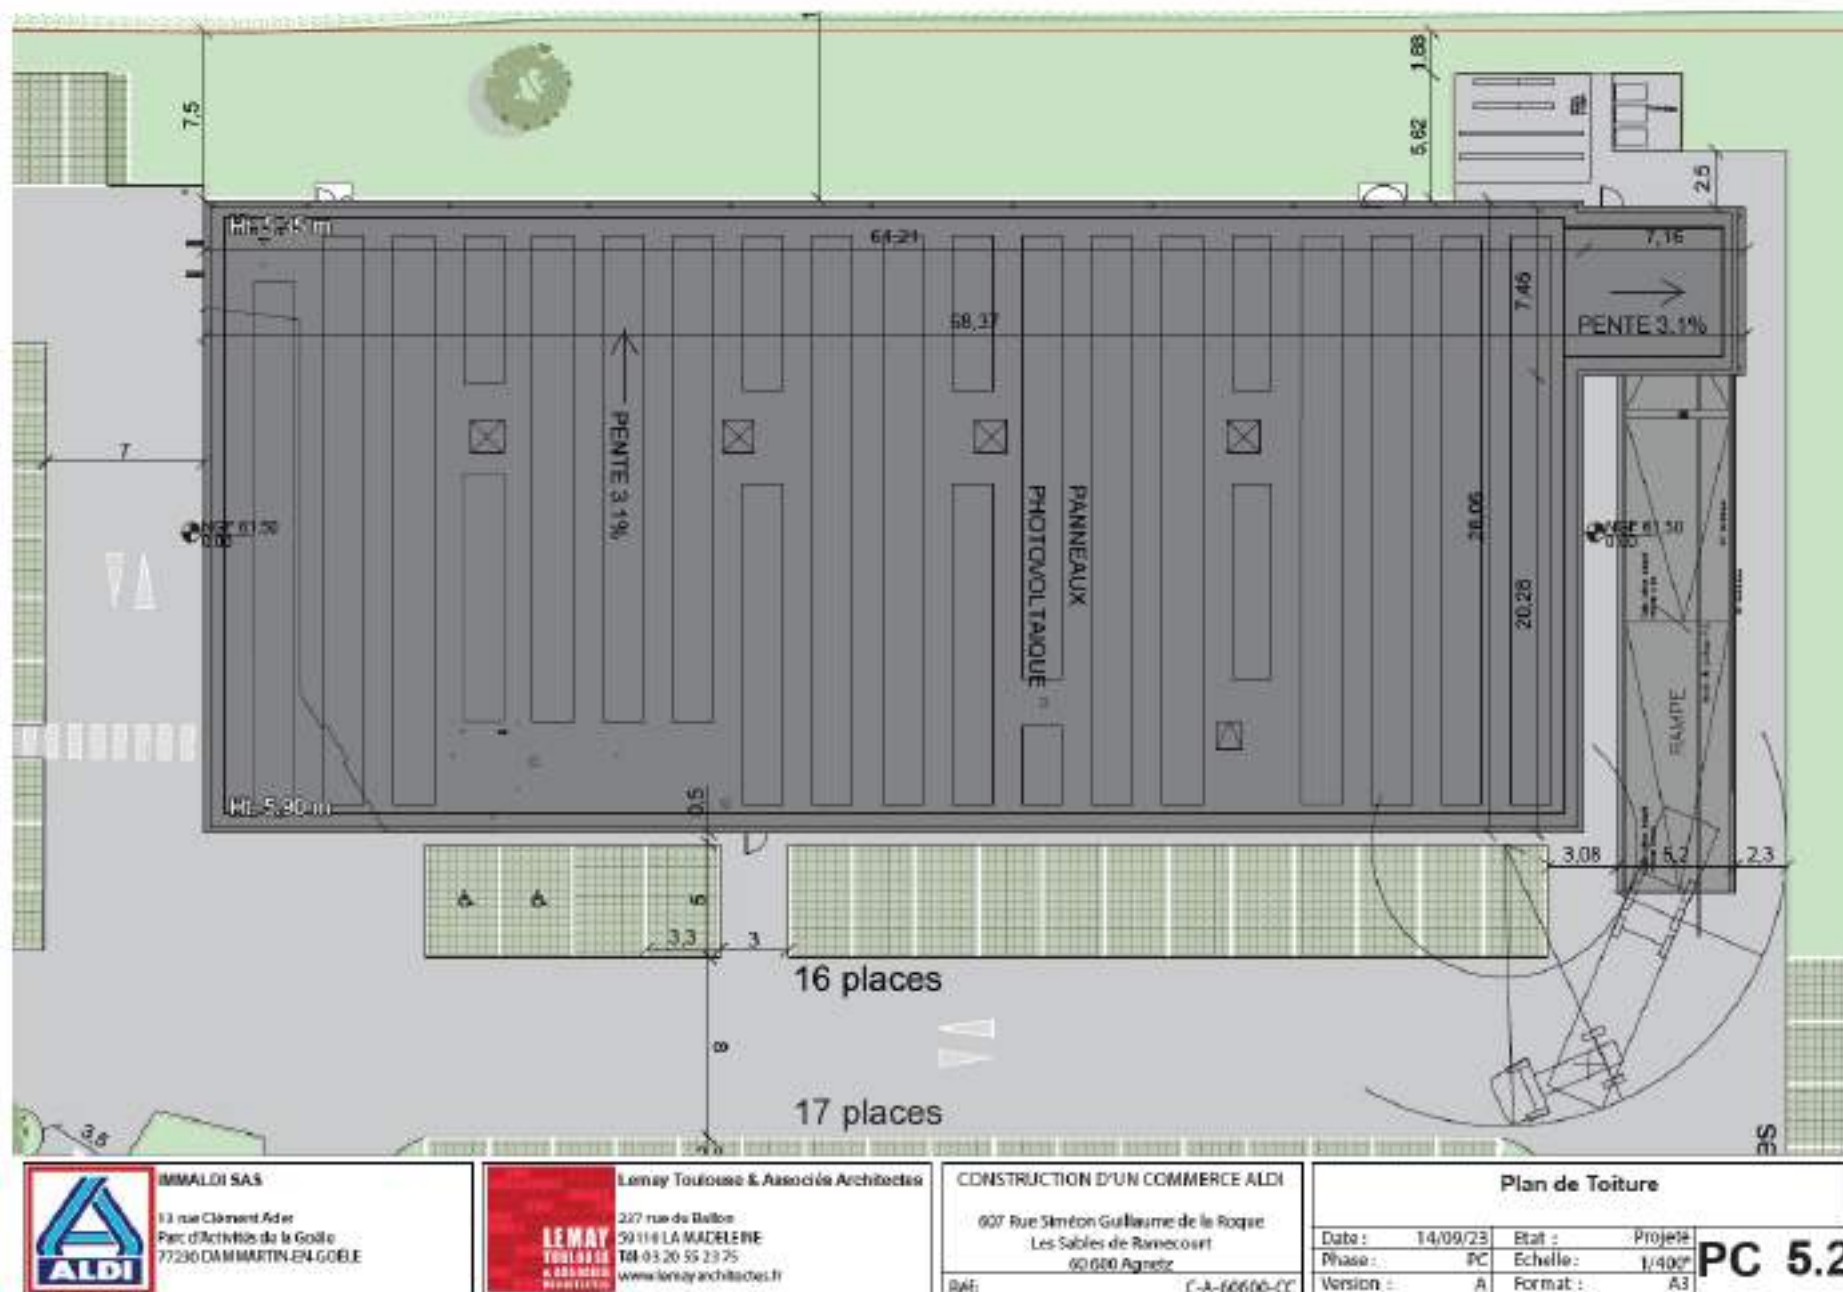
Plan de toiture du projet – Source : Aldi et LEMAY
